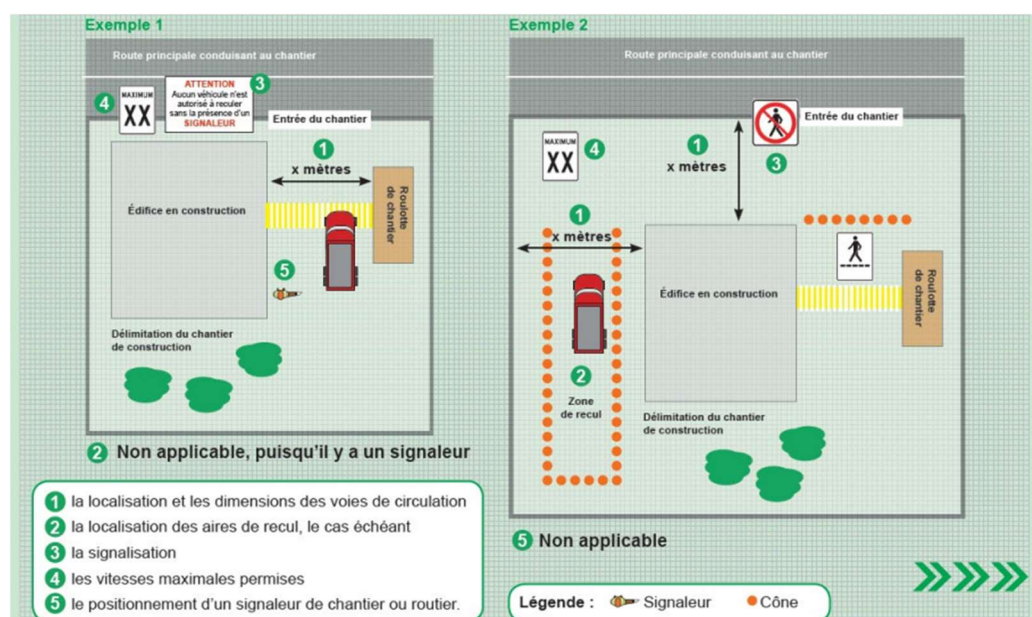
Exemples de plans de circulation de chantier (Bélon LA POINTE, 2019)
